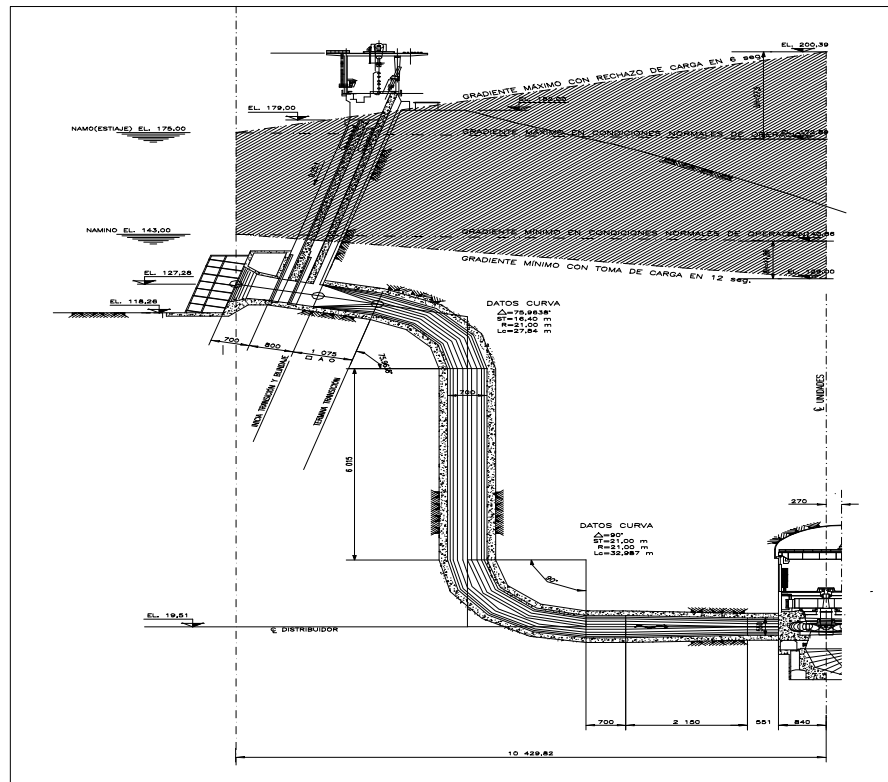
Corte longitudinal por el eje de la conducción de las tuberías a presión
